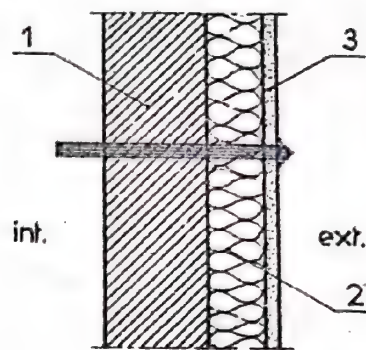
Perete de beton cu termoizolație la exterior. 1-Beton; 2-Tencuială interioară; 3-Tencuială exterioară.
